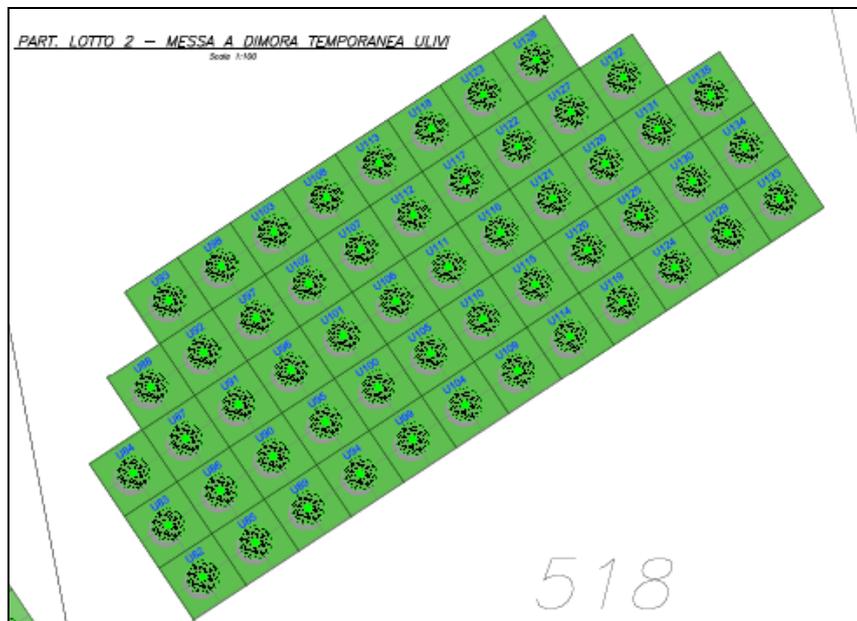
Schema di impianto degli ulivi trapiantati Lotto 2
